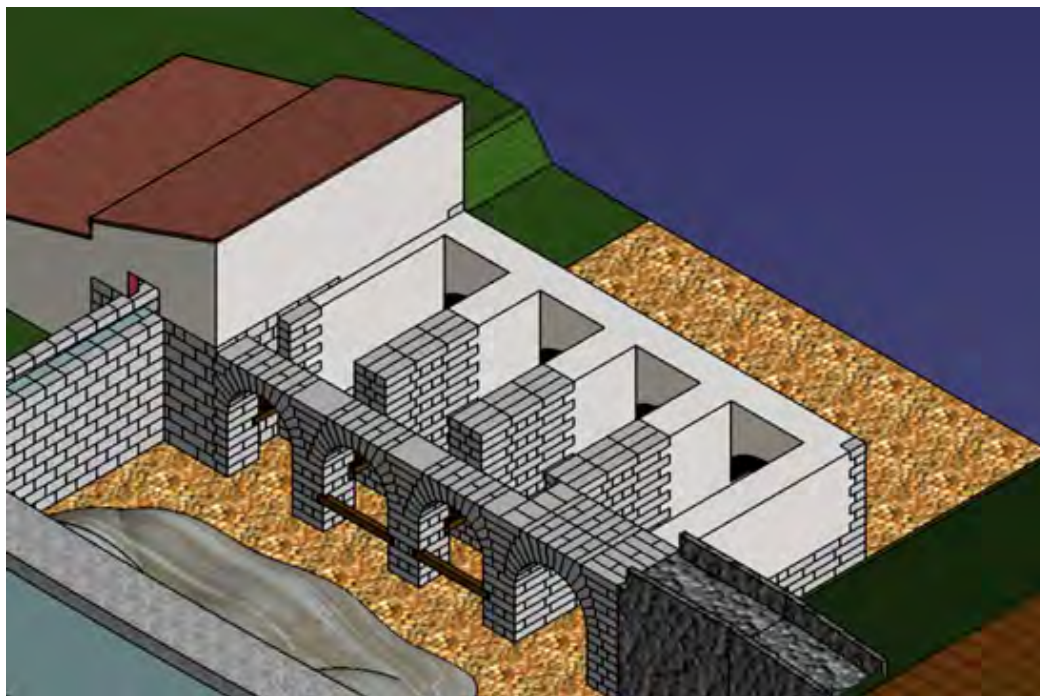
imagen de la reconstrucción de la planta baja del molino de mármol.
